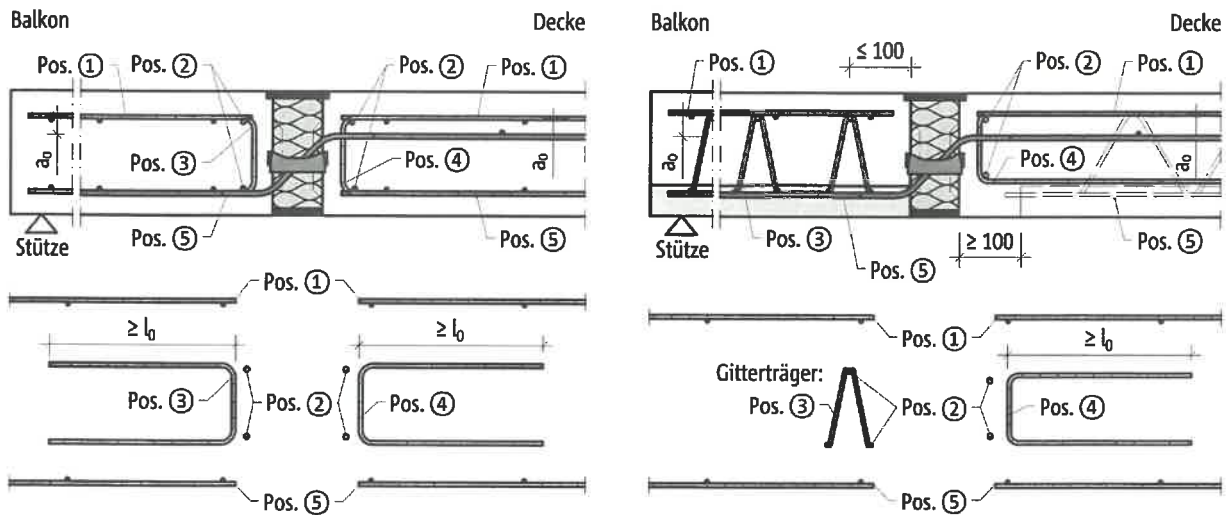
Schöck Isokorb® T Typ Q-V6 bis -V12 6.0, indirekte Lagerung: Bauseitige Bewehrung bei Ortbetonbauweise (links) und Fertigteilbauweise (rechts) schematisch dargestellt
